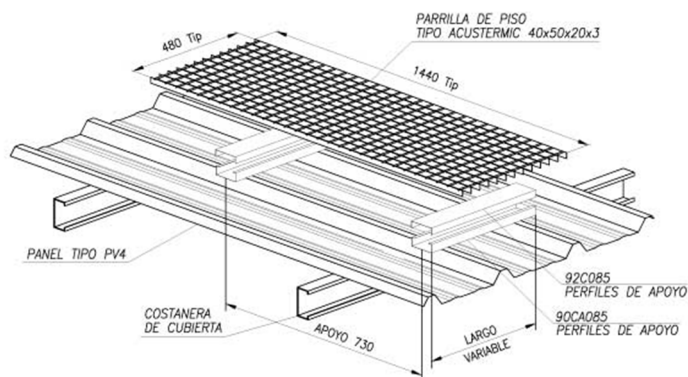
Detalle típico montaje pasillo técnico sobre cubierta plana.
